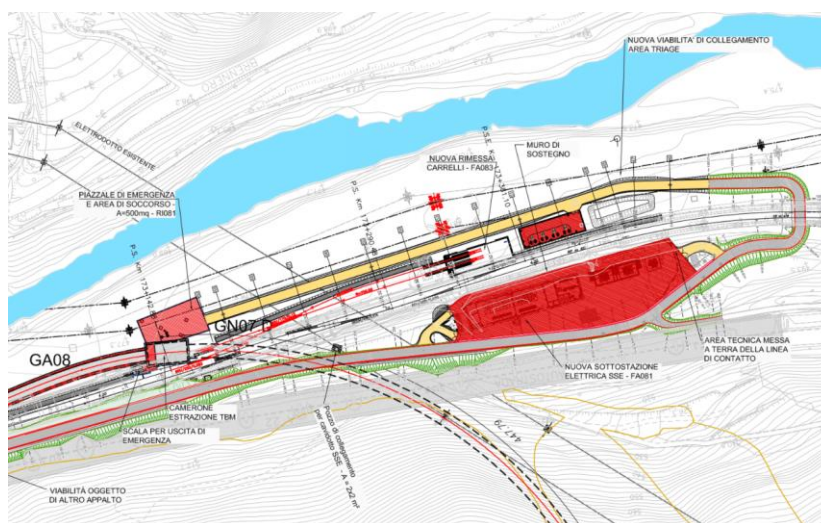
Planimetria di PD in zona Ponte Gardena - configurazione dei tralicci Terna modificata
